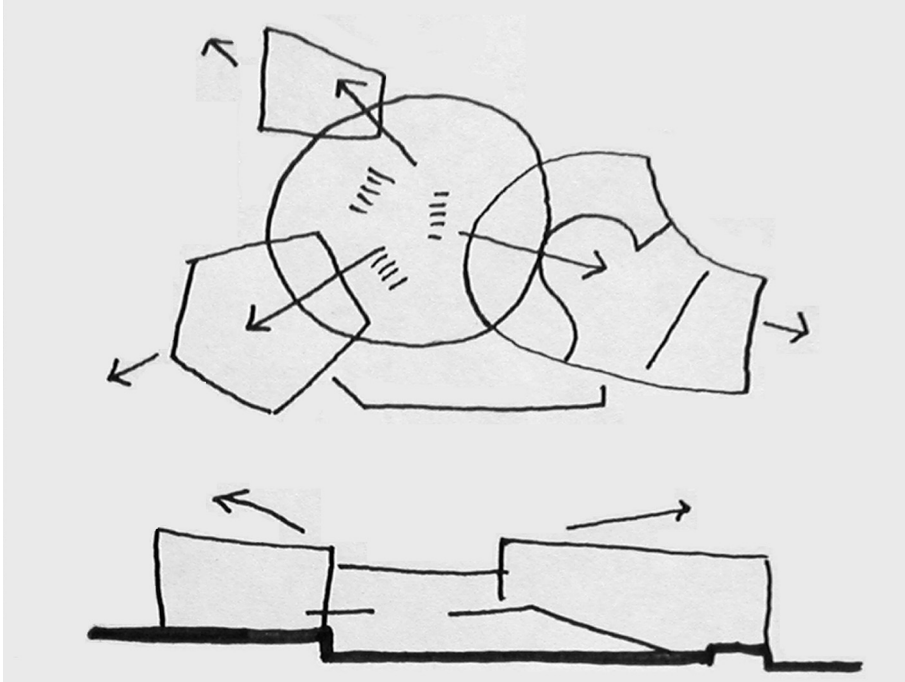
Grundriss- und Schnittschema. Skizzen: Nikolaus Ruff, 1995.
